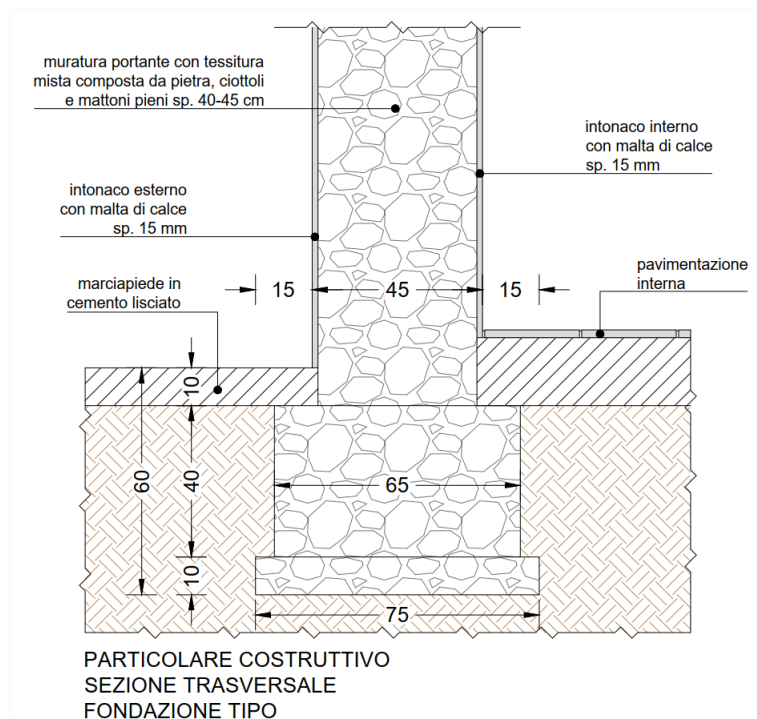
Sezione tipo fondazione e muratura – Sezione trasversale
